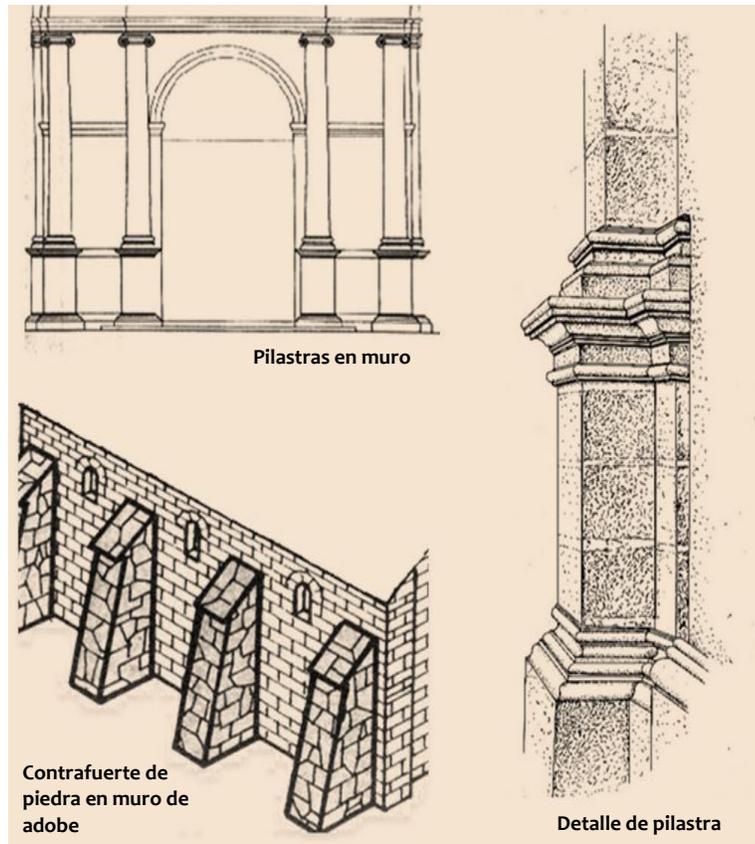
Apoyos aislados: pilastras y contrafuerte.
